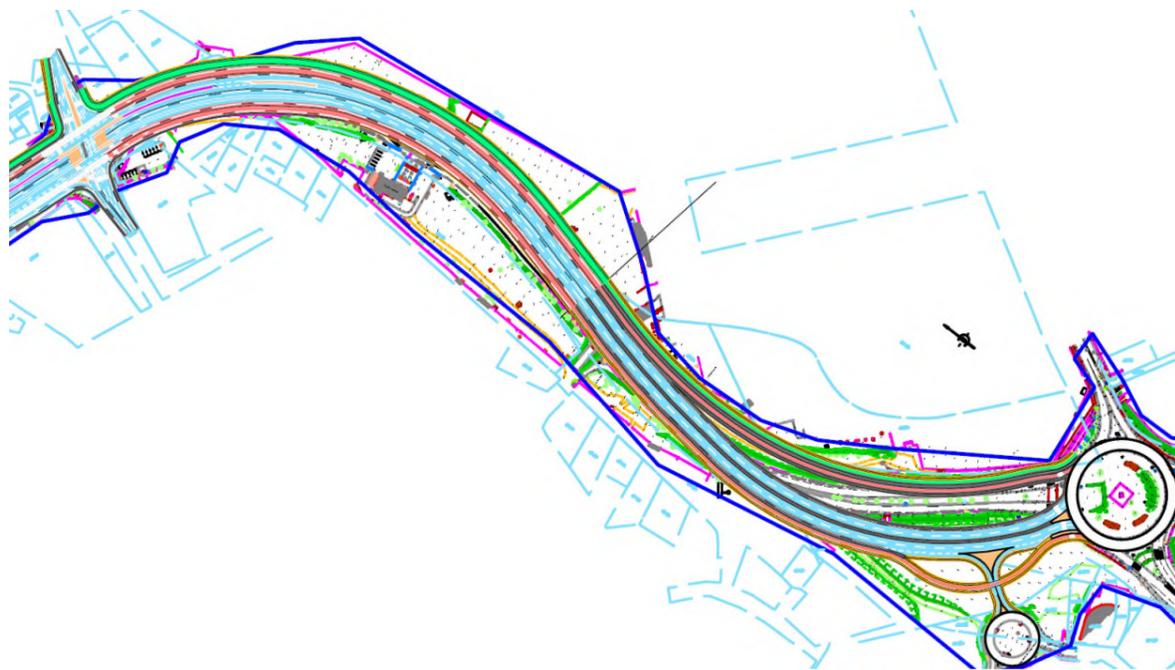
SCÉNARIO 3 : TCSP EN POSITION BILATÉRALE : PLAN GÉNÉRAL SYNOPTIQUE – ZOOM SECTIONS 1 ET 2 : LE CONARDEL – OA MARSOUINS
